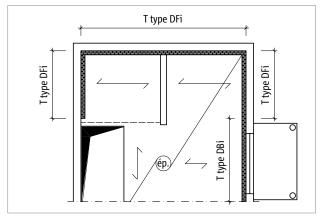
Schöck Rutherma® T type DFi : utilisation entre la dalle et la façade
